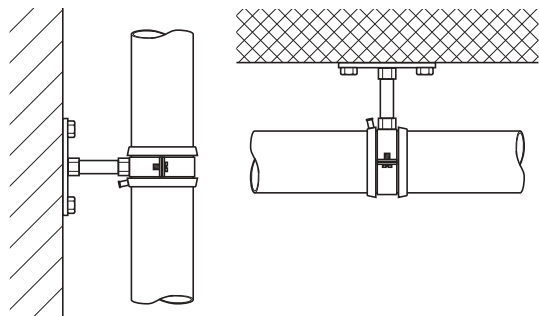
Fixation verticale et horizontale de point fixe sur la bande à souder électrique Geberit
